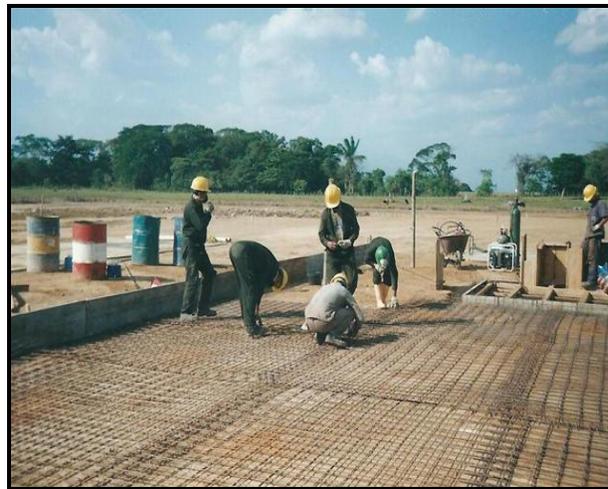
Obras típicas de construcción de contrapozo y plataforma.
